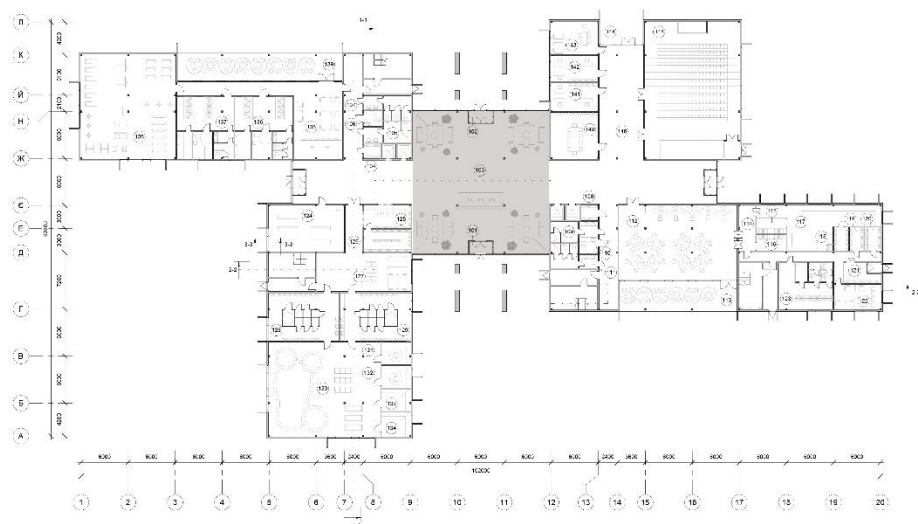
Розміщення холу на плані поверху запроєктованої будівлі
